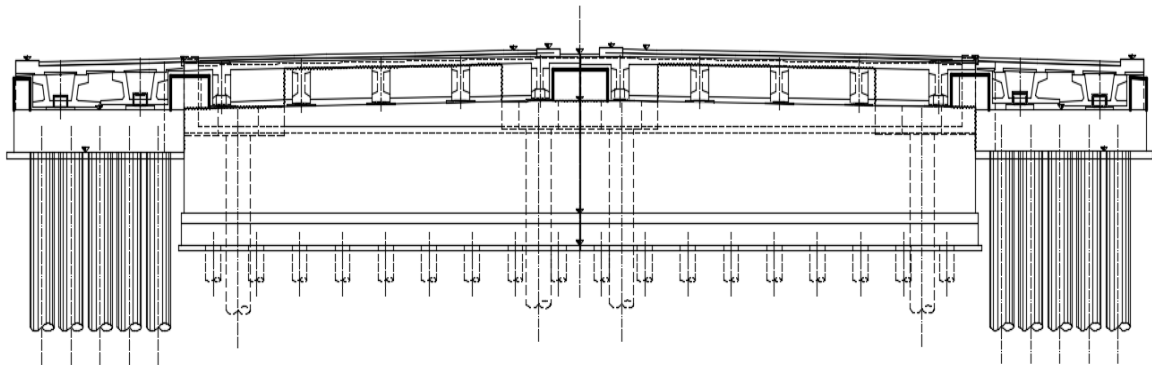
Prospetto spalla con notazione ritegni trasversali
